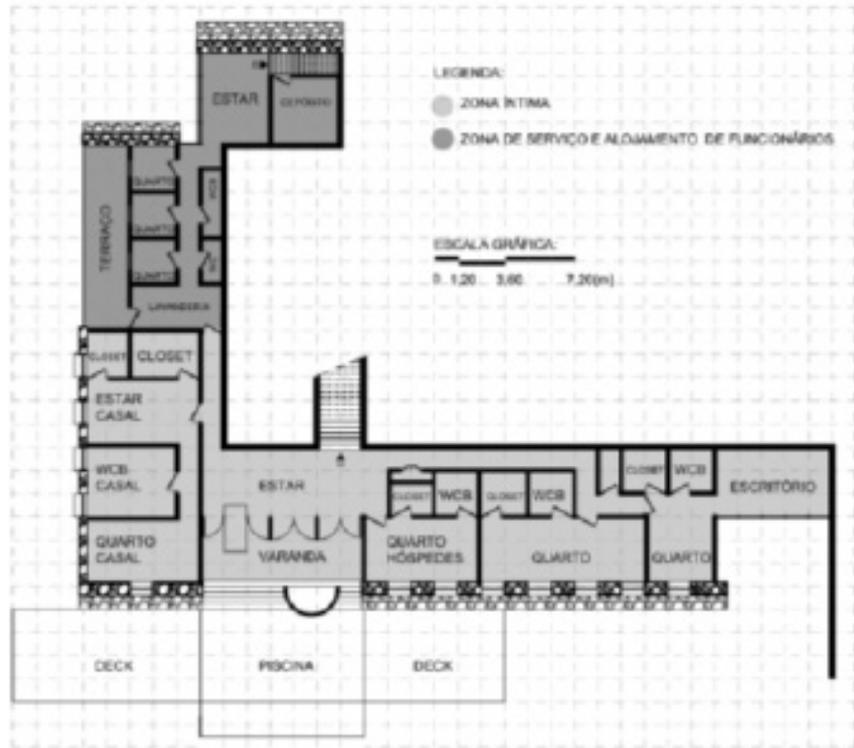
Planta Baixa pavimento inferior da casa do arquiteto Sergio Bernardes redesenhada pelo autor.
